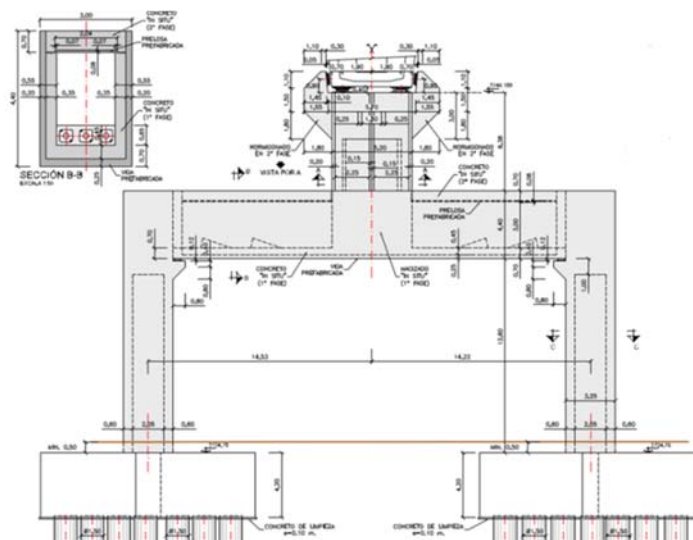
Alzado pila pórtico y sección transversal del dintel.
